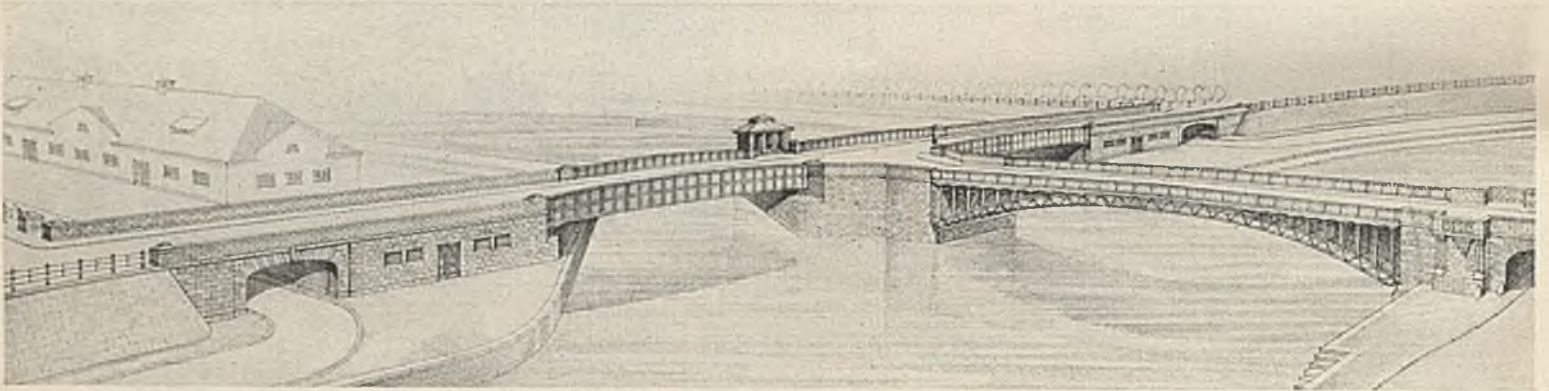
Entwurf aus dem Jahre 1924 (nicht zur Ausführung gekommen).
